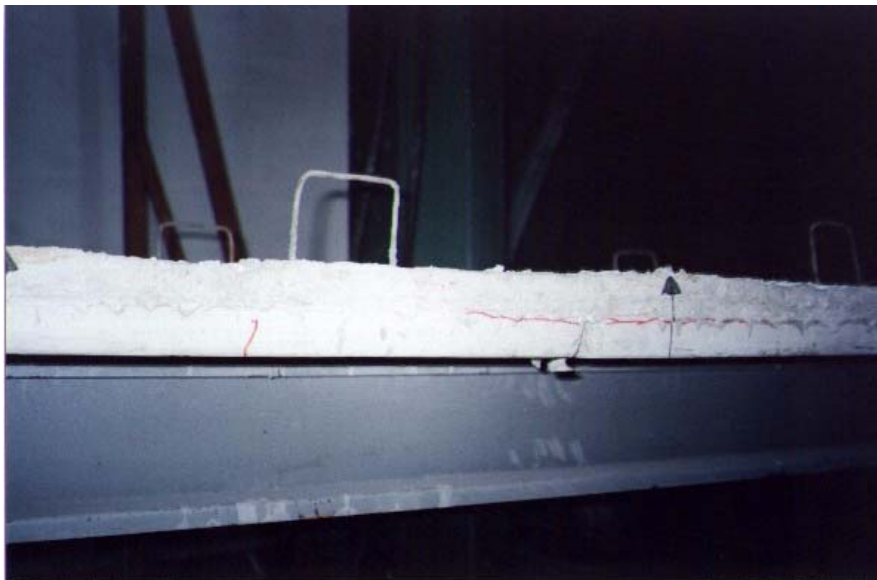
Detalhe da separação entre o capeamento e a pré-laje ao longo do vão.
